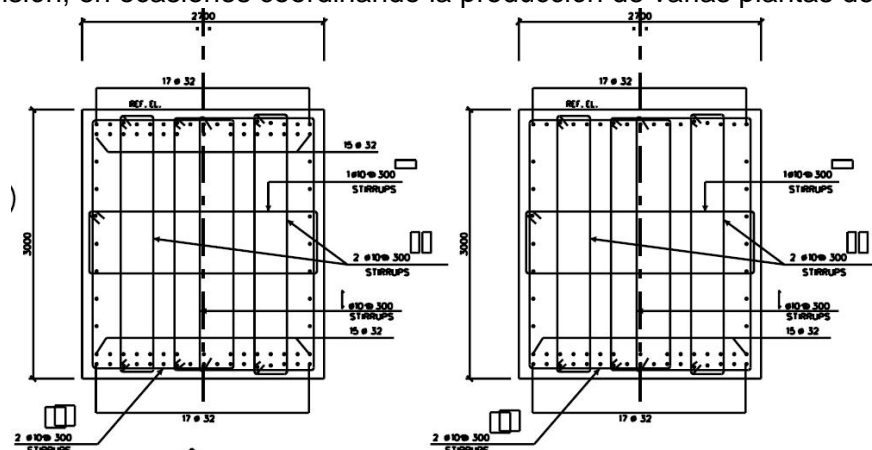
Secciones y armados típicos de vigas de la estructura soporte de hormigón
